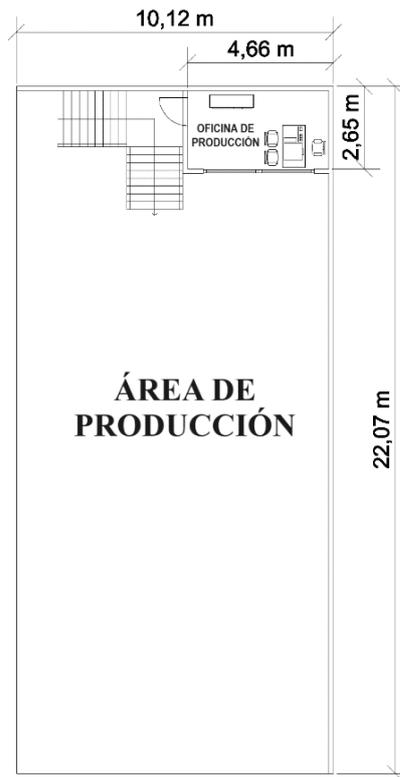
Layout de la Base 1 de López Torres Industrial
